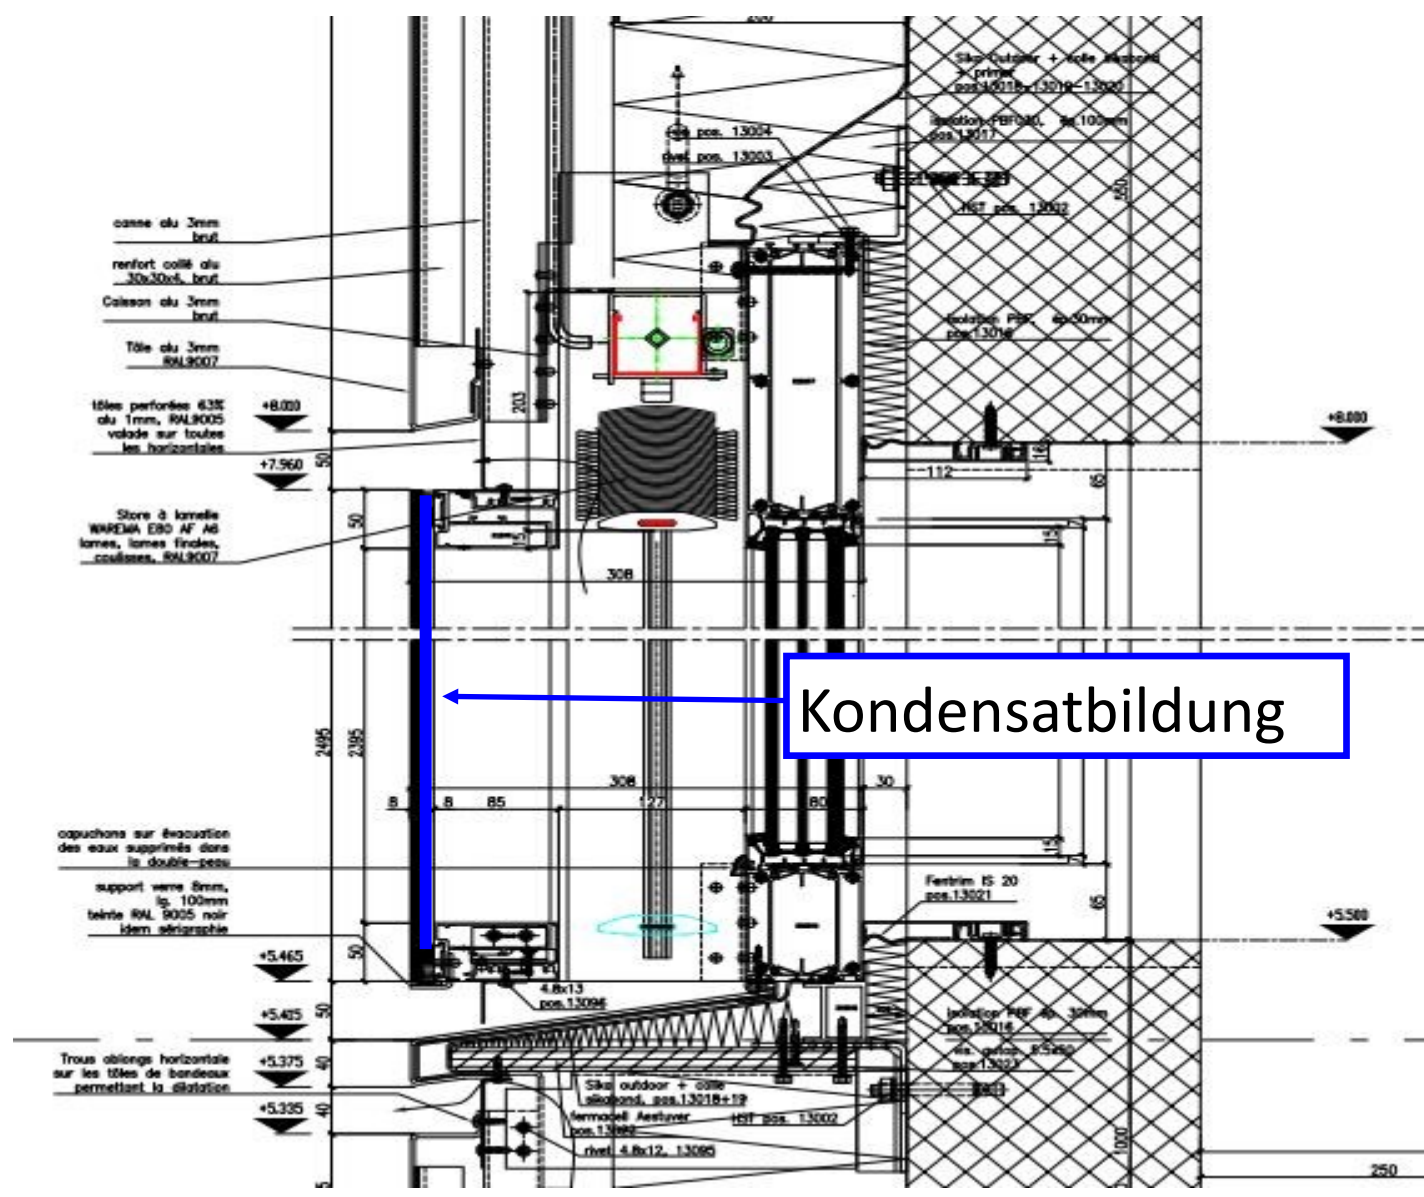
Planausschnitt des Vertikalschnitts der Doppelhautfassade
